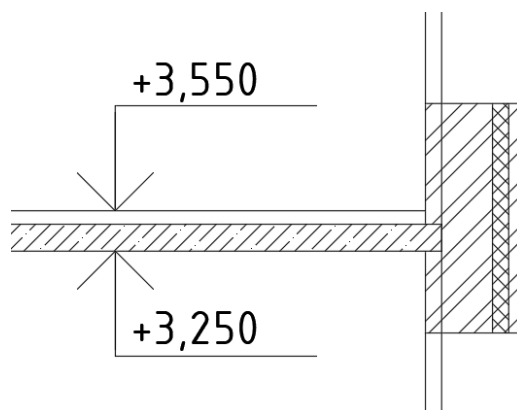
Схема расположения проектируемой плиты перекрытия
